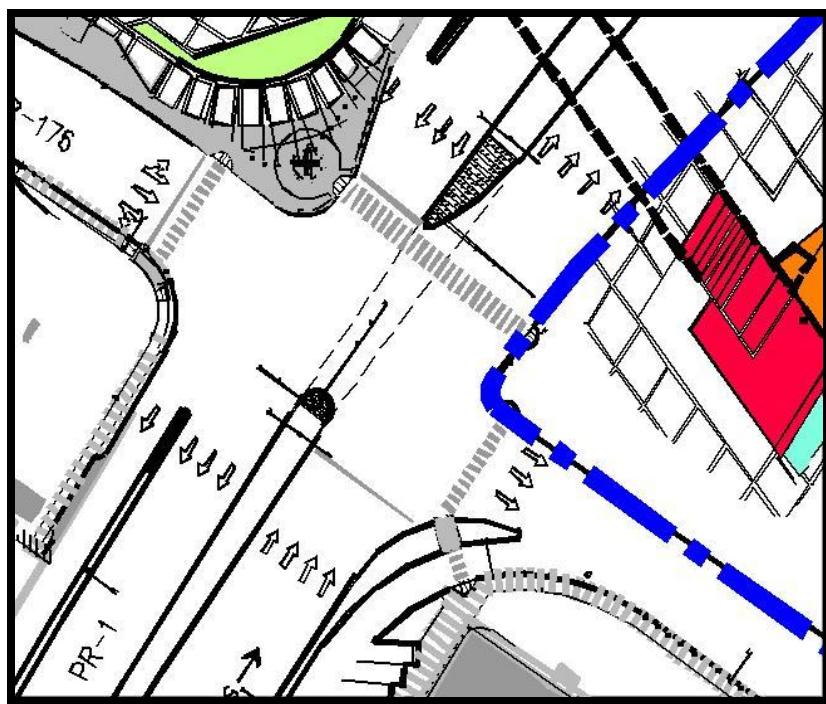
Int. PR 1 con PR 176 Geometría Propuesta
